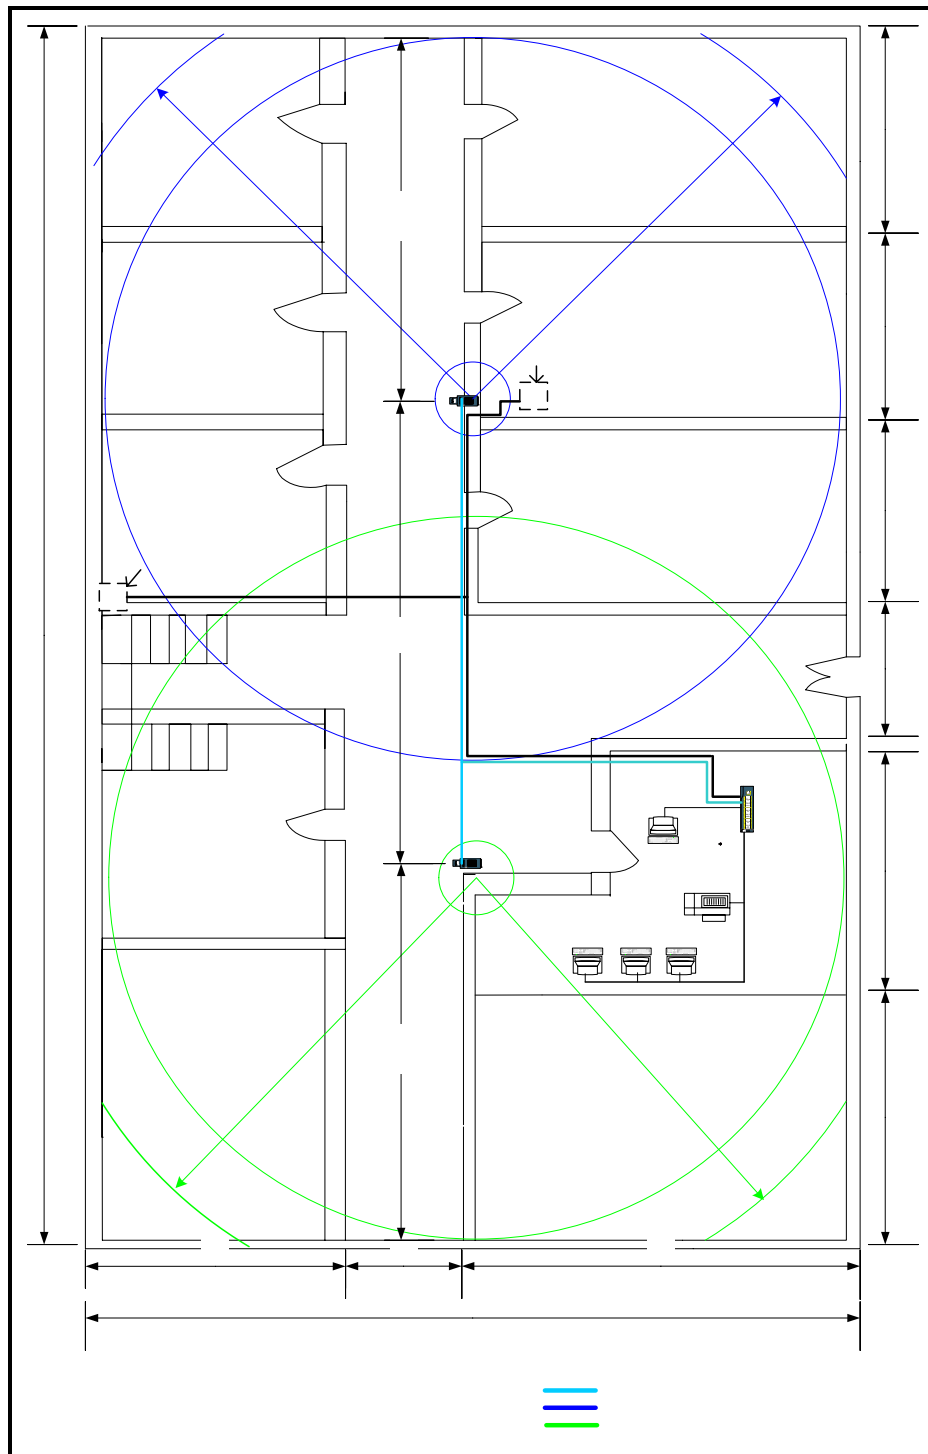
Cobertura inalámbrica en la Planta baja del edificio de Lenguas
